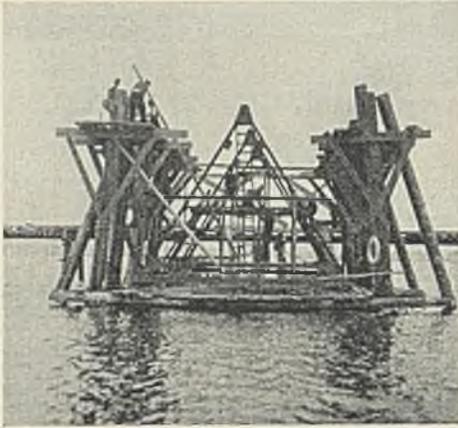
Eisengerippe des Senkkastens des Pfeilers E (von vorn gesehen) und Absenkgerüst im Bau.
